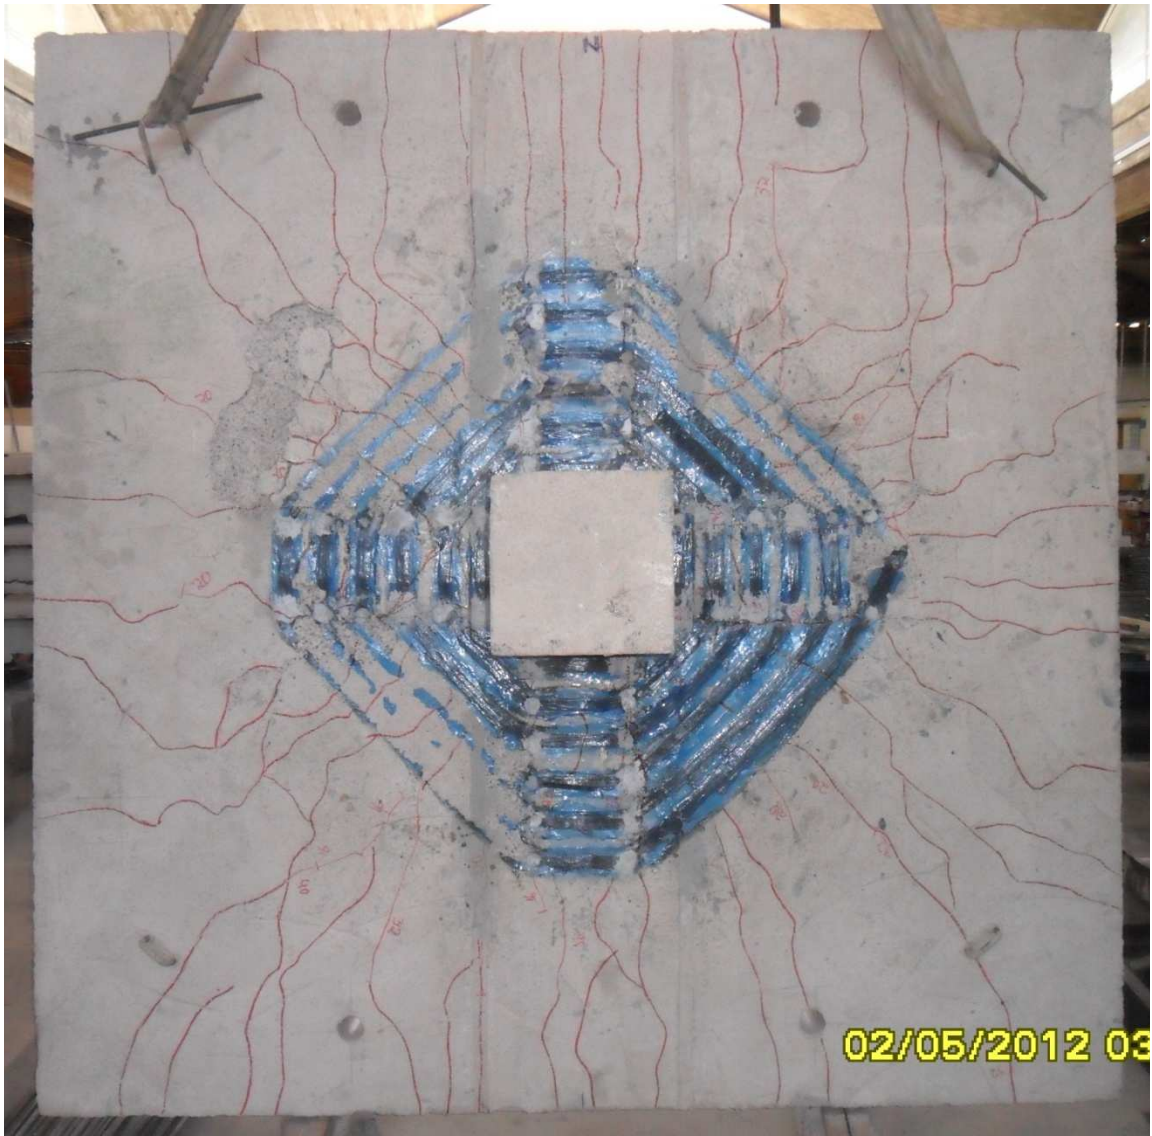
Padrão de fissuração do modelo LC-S2
